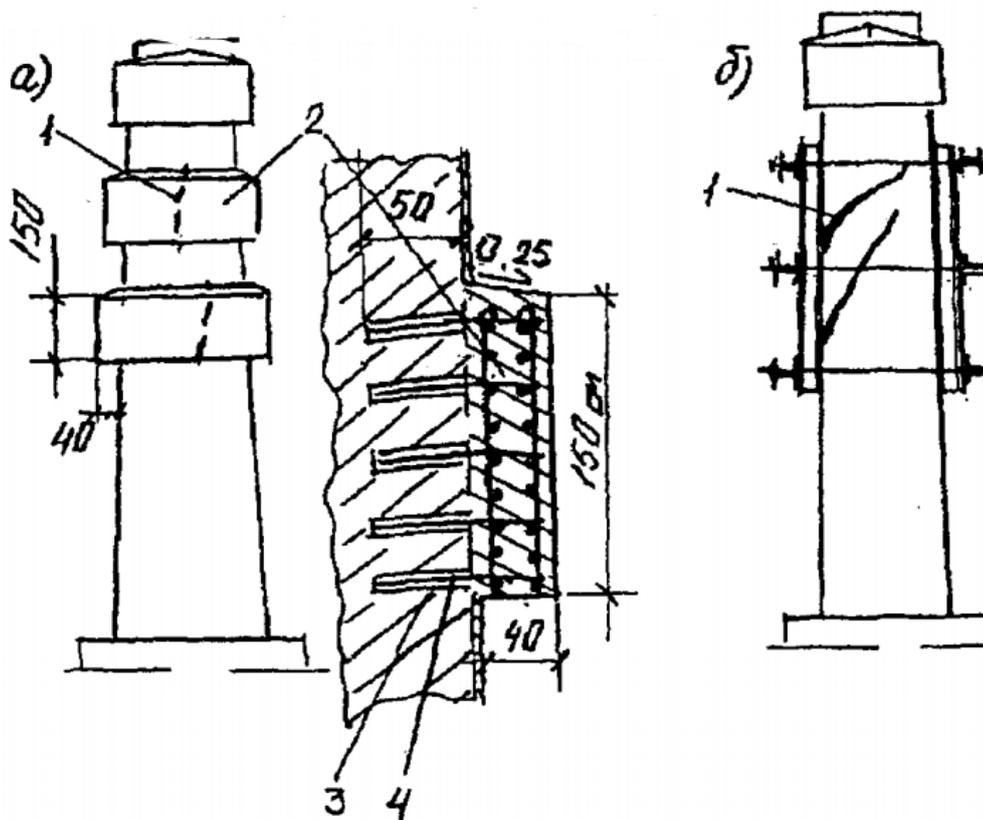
Железобетонные пояса и стальные бандажи опоры:
